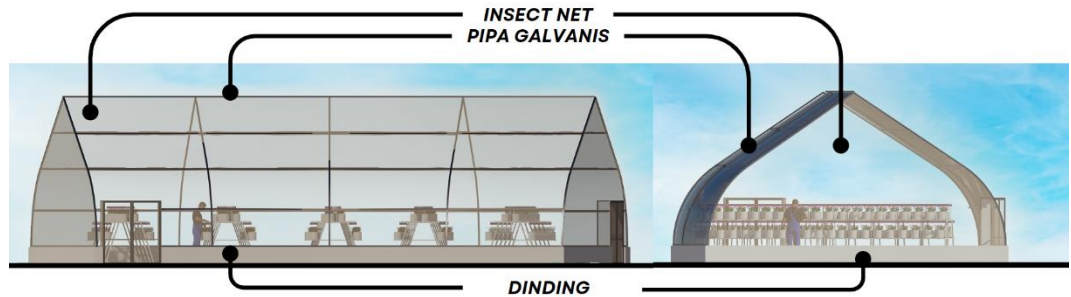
10 Aplikasi Struktur Bangunan dan Struktur Atap
